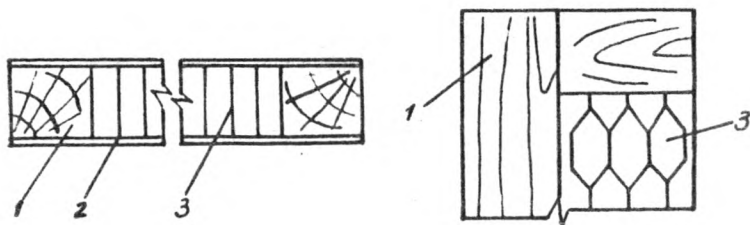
Конструкция плитного материала: 1 - бруски рамки, 2 - обшивка, 3 - бумажный сотовый наполнитель
